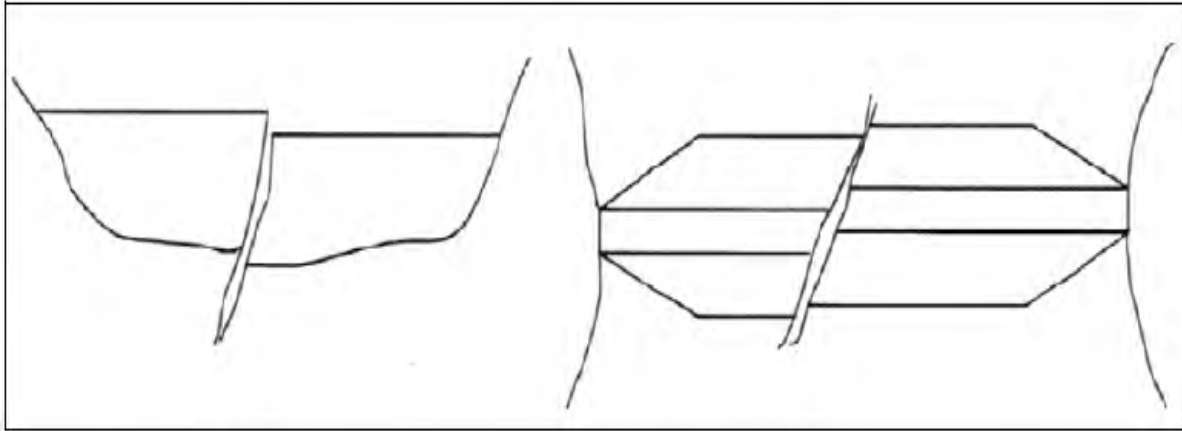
Desplazamiento de fallas, vertical y horizontal (elevación y planta)
